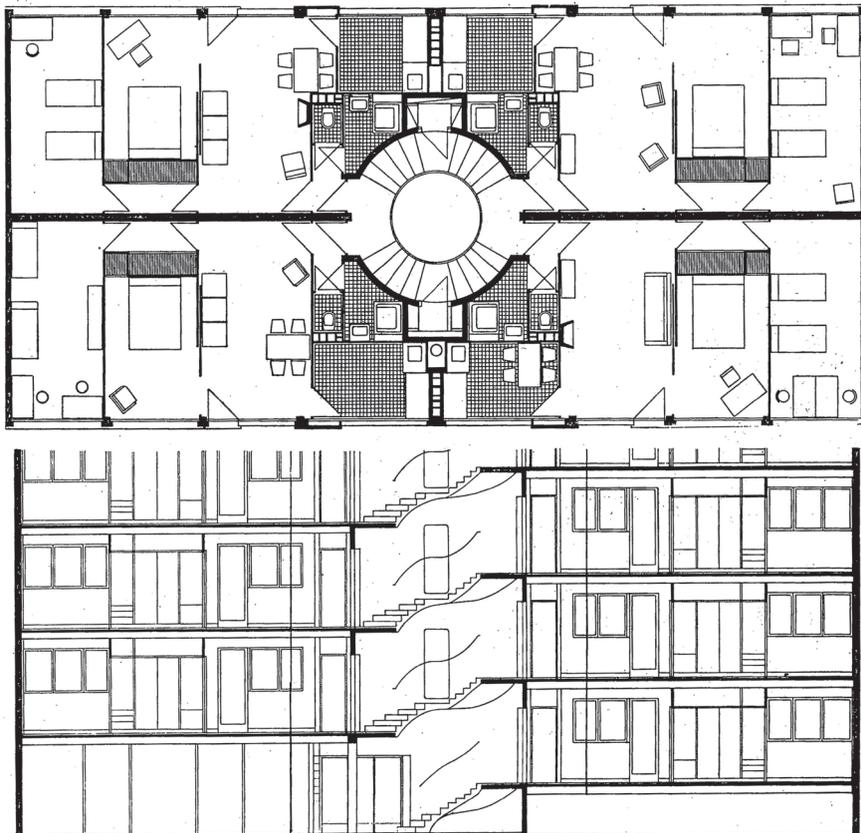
Plan d'un étage courant et coupe d'un immeuble barre, 1954. L'escalier de forme hélicoïdale est éclairé naturellement par un dôme surbaissé en pavés de verre.
